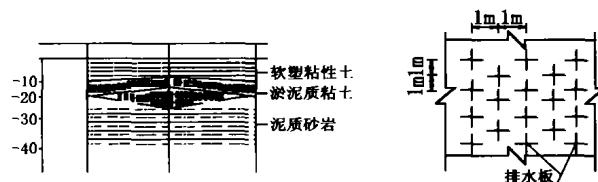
工程地质纵断面图 图 2 排水板平面布置示意图
